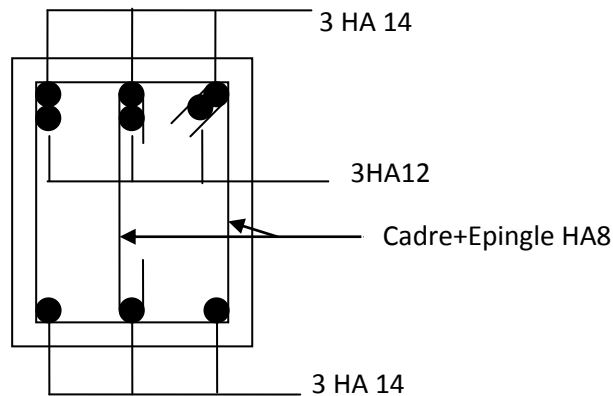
Schéma de ferrailage de la poutre brisée de l'escalier type II.
